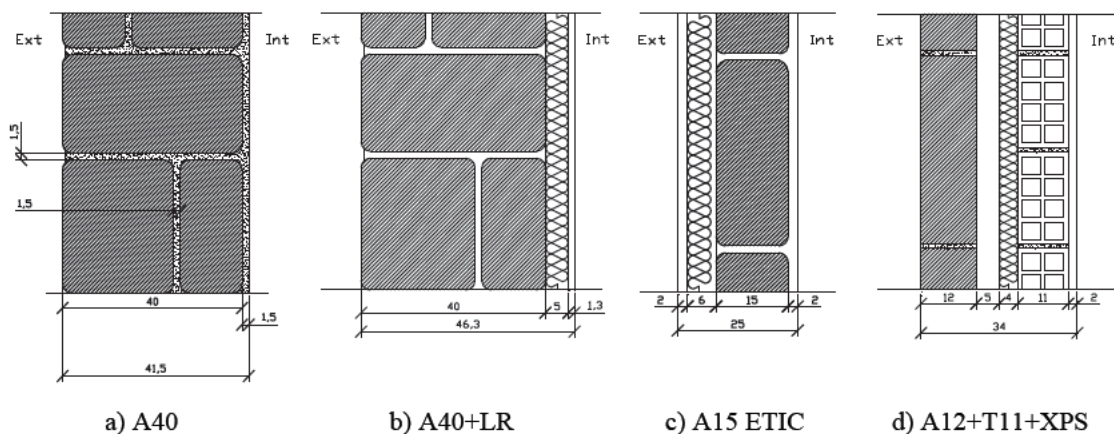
Secção tipo de paredes de alvenaria em pedra: (a) simples estrutural tradicional; (b) simples com isolamento interior; (c) simples com isolamento exterior (sistema ETIC); (d) dupla com pano interior em tijolo furado.
